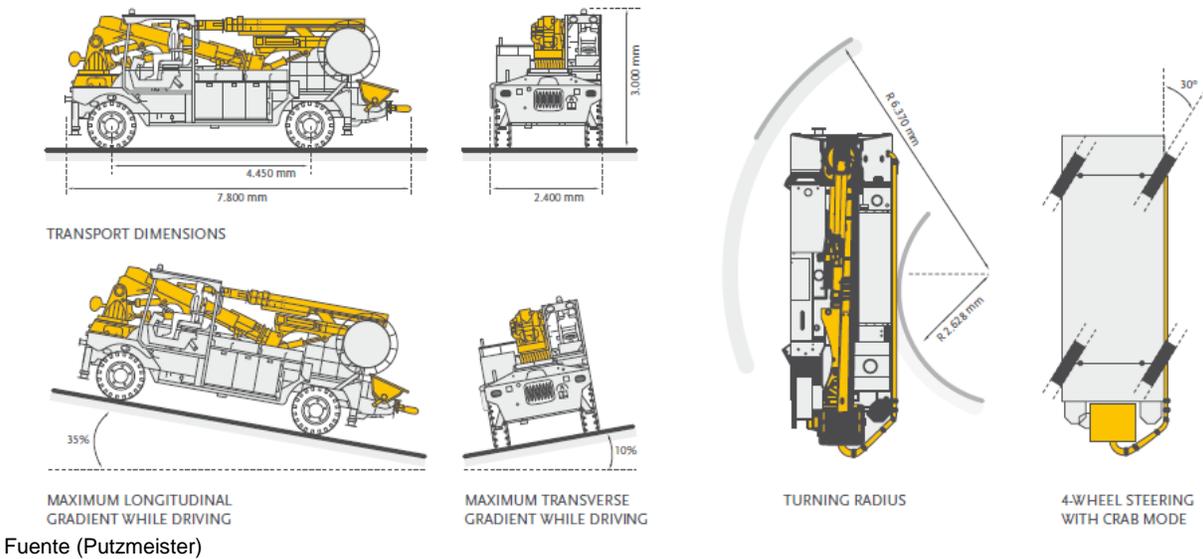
Aplicación concreta lanzado mediante PM-500
